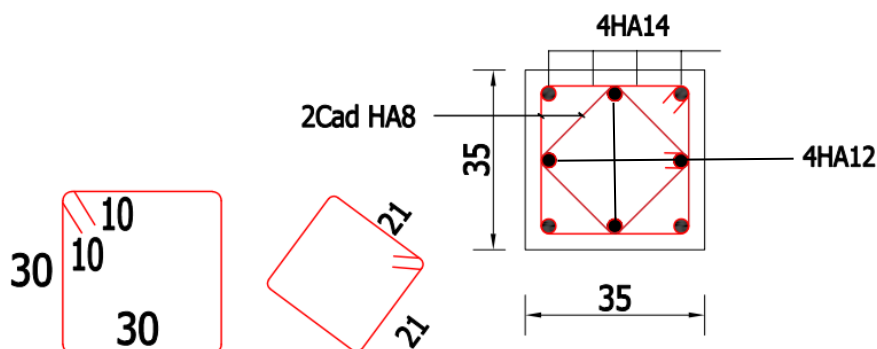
Schéma ferrailage Poteaux (35 x 35)
